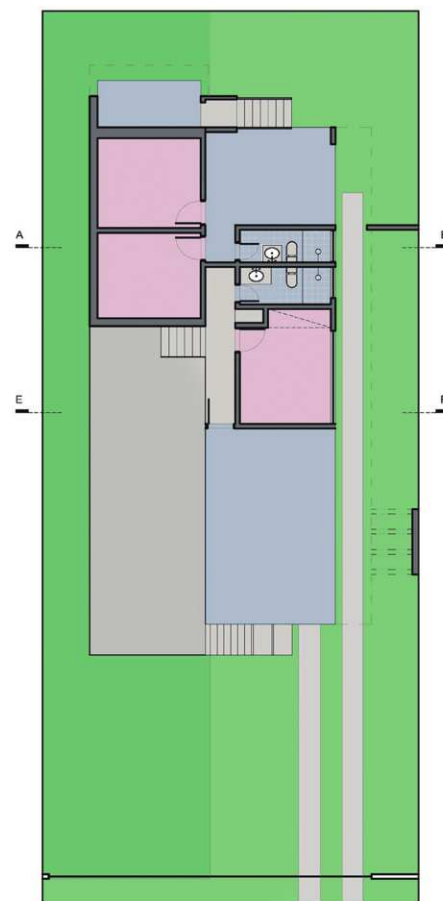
Planta baixa pavimento porão. Fonte: Arquivo Municipal, 2017.
